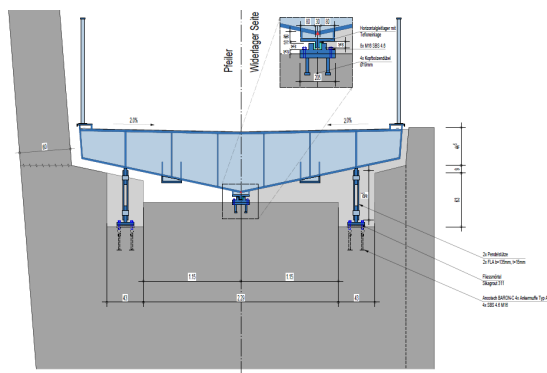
Detail Lagerung Pfeiler und Widerlager Seite Ruggell
